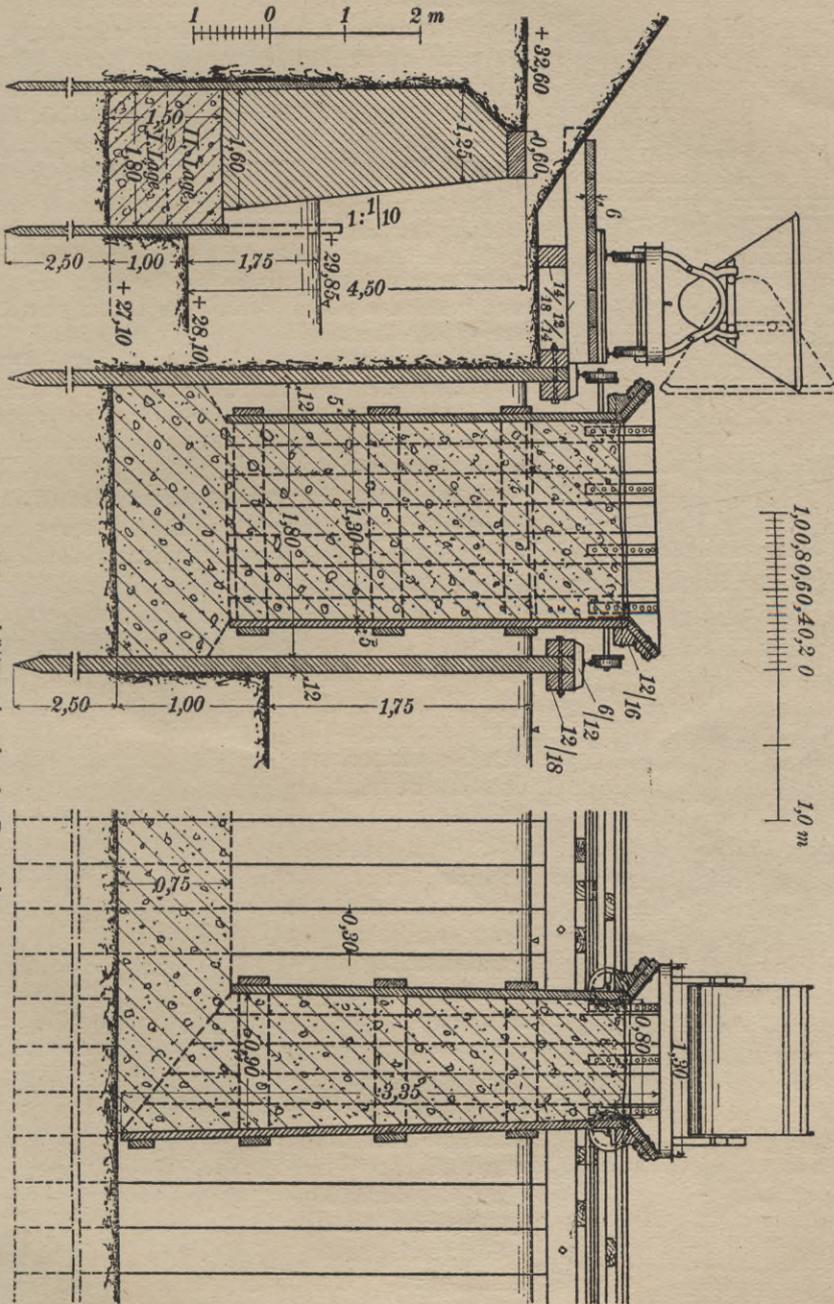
Beton-Trichterschüttung in schmaler Baugrube.
